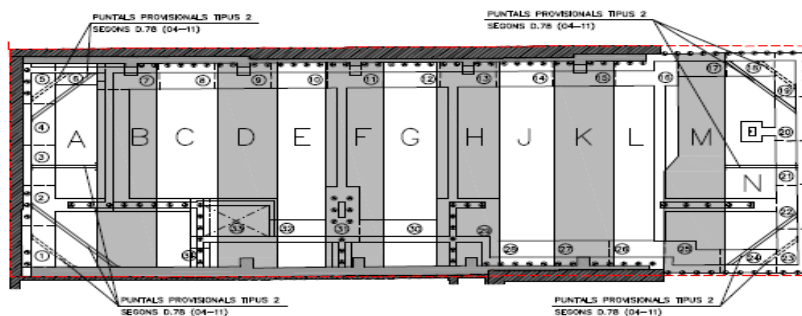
Planta del solar objeto de estudio en fase de estructura
